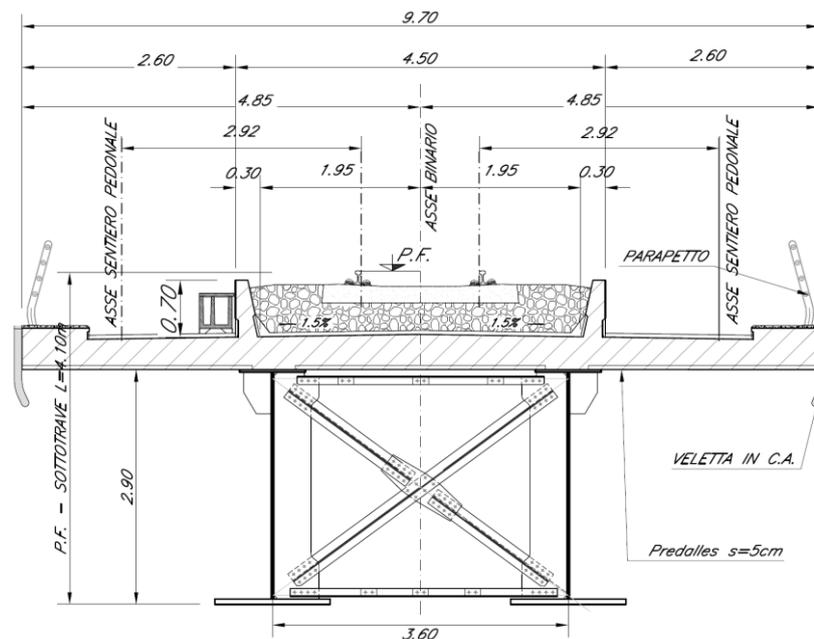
Sezione trasversale campate in acciaio-clc L=40 m
